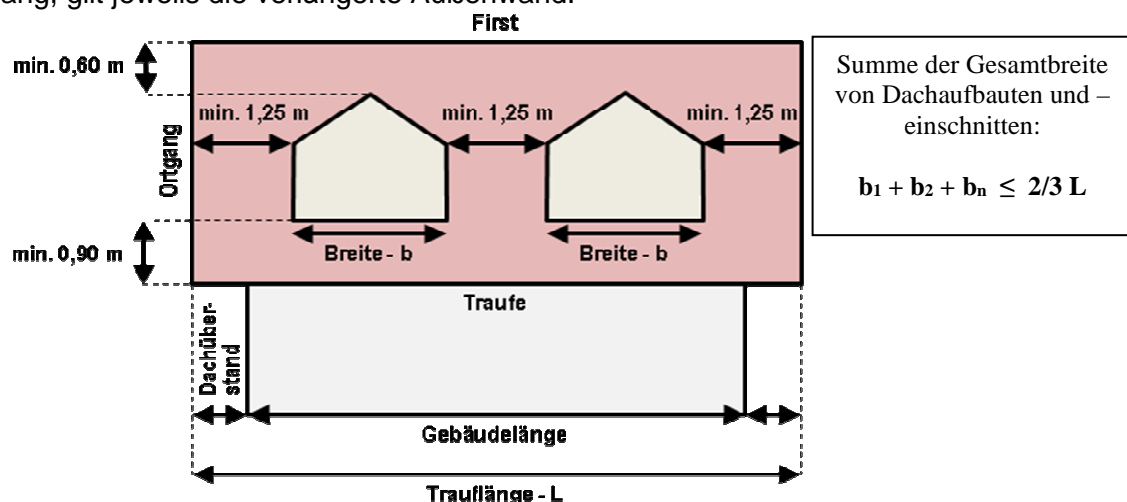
Abmessungen zulässiger Dachgauben (hier Beispiel: Sattelgaube)
